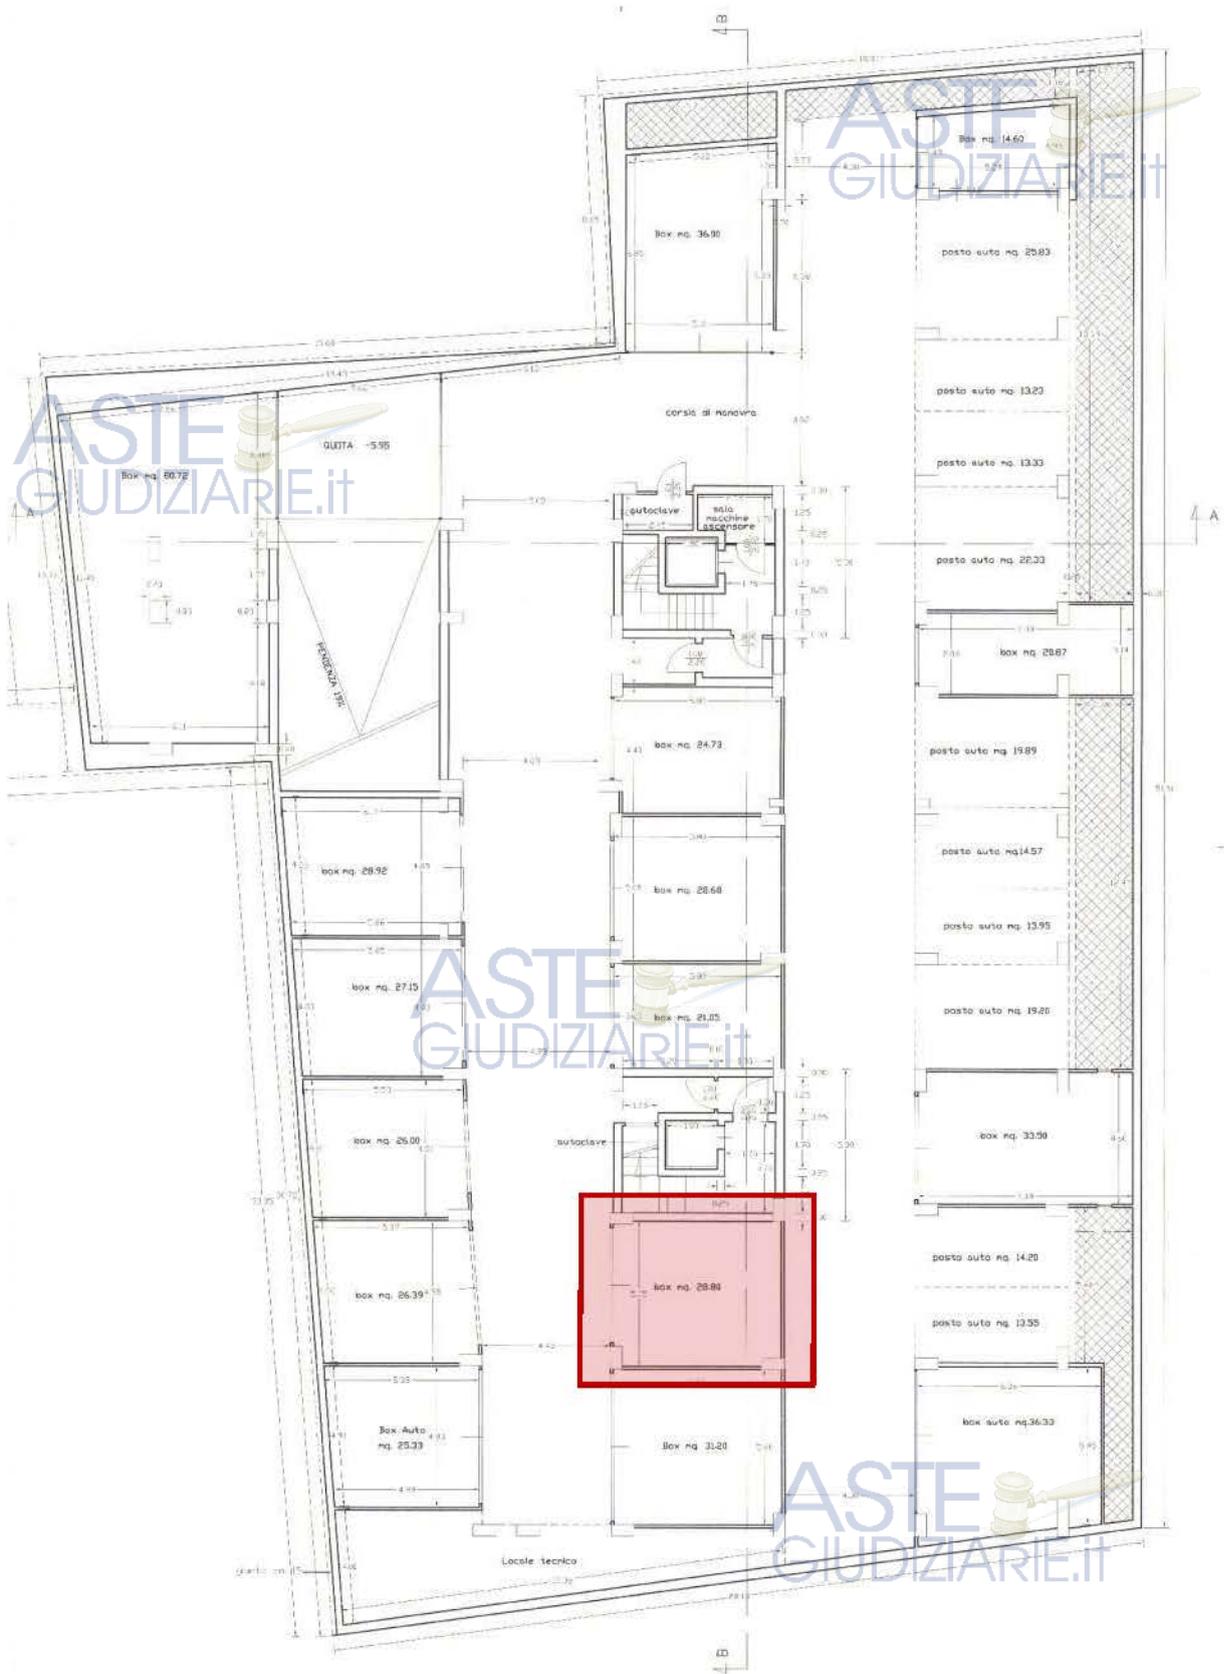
Tav. 01 - Pianta Piano Sottostrada 2° livello Quota -5.80 m (C.E.73/2011) con indicaz. del Sub 50
